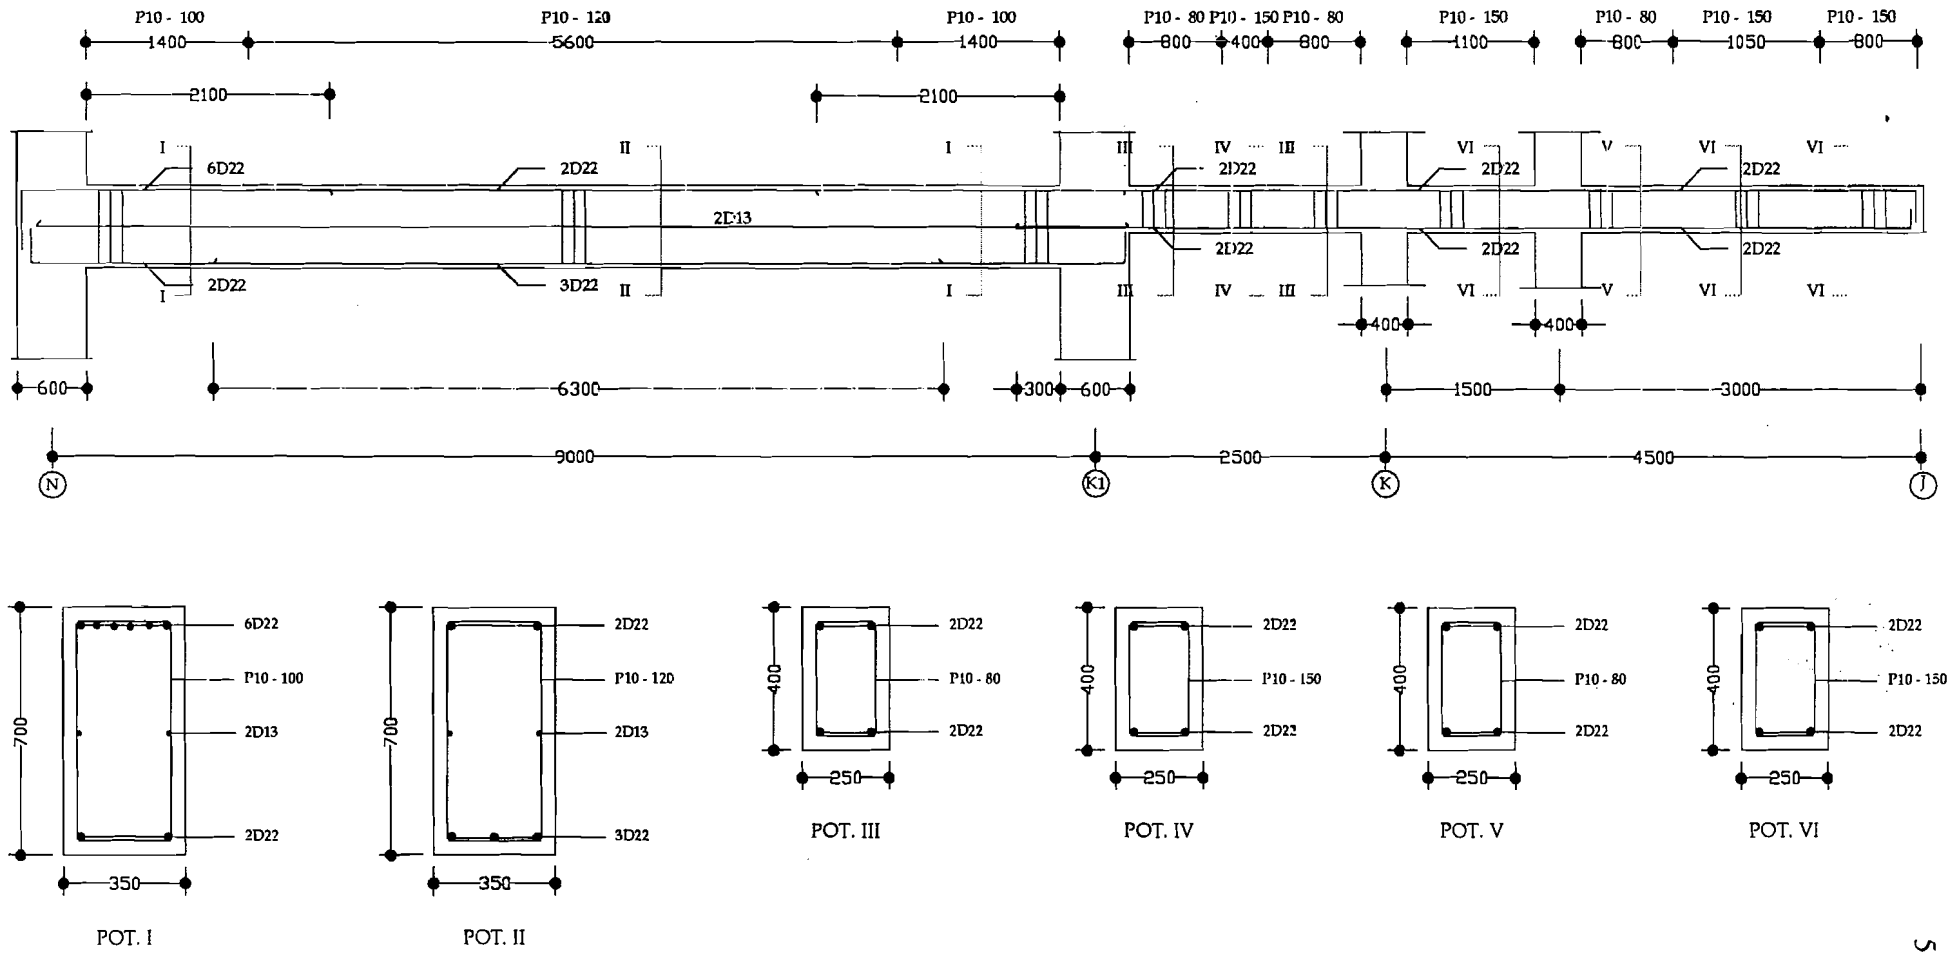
Denah Rencana Balok Induk Lantai 3
